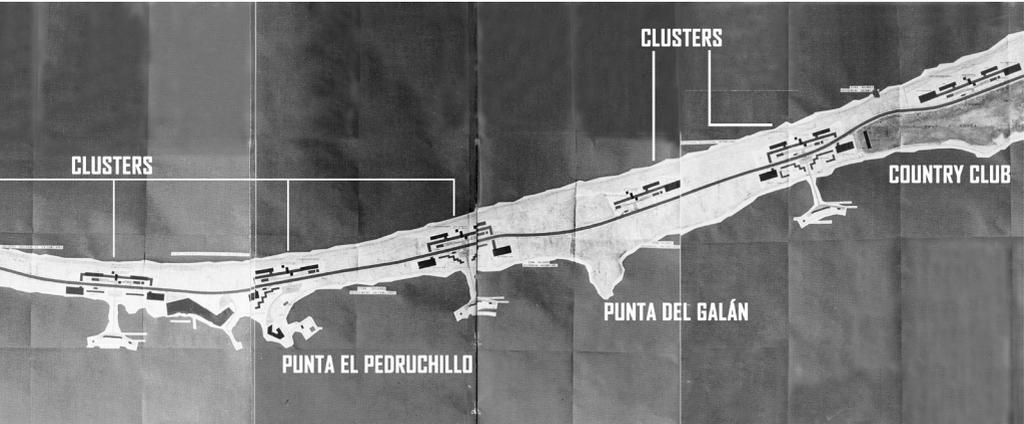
Plano correspondiente al denominado "Plan Norte" elaborado por A. Bonet (1961)
